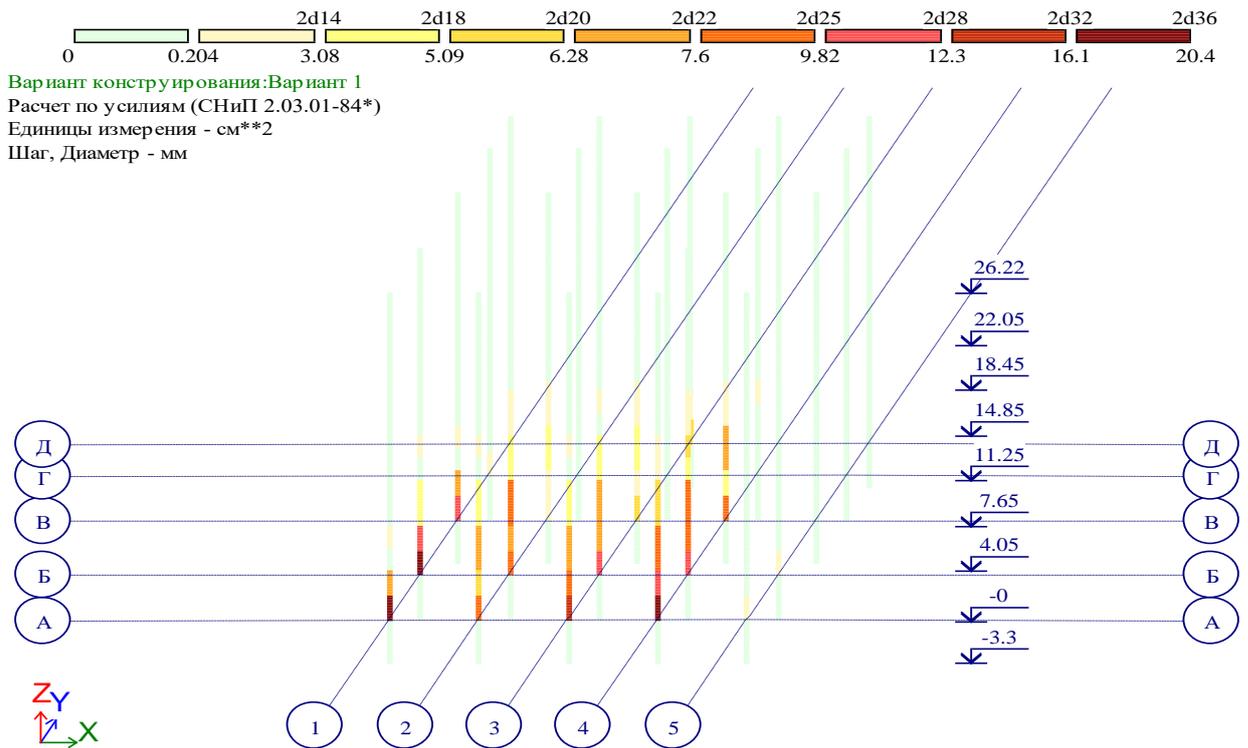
Армирование колонн сечением 400x400 мм. Симметричное армирование.
